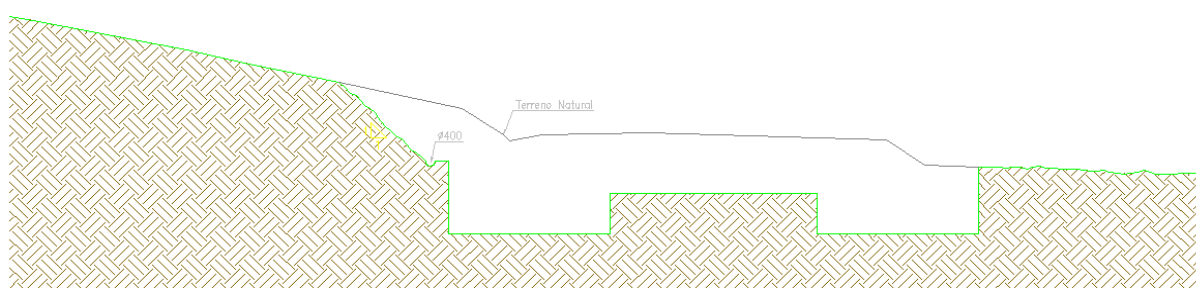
Fase 1 - Escavação (COBA *et al.*, 2008)
